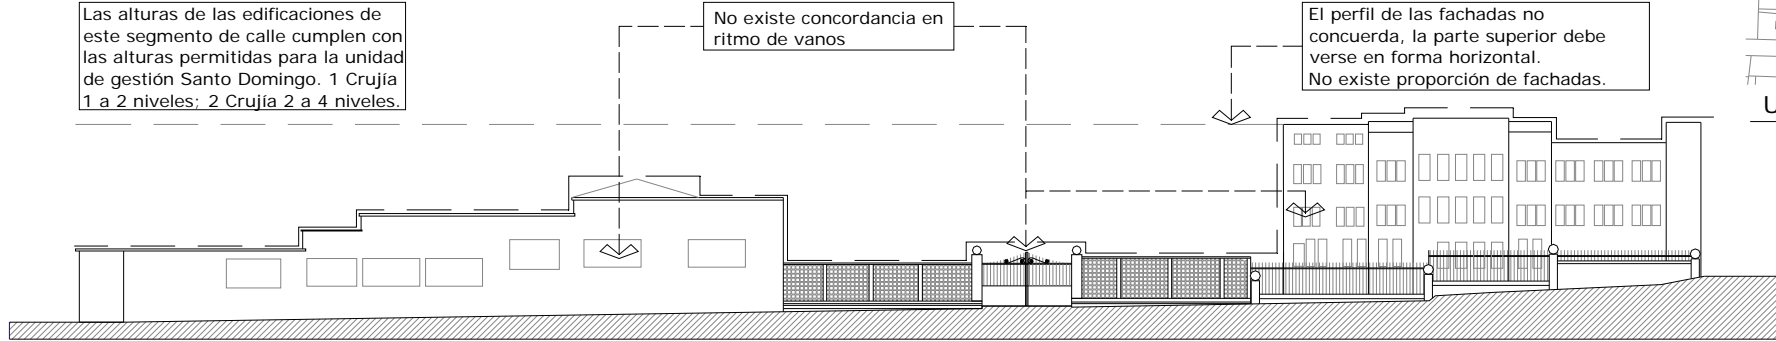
CALLE "A" SUR ENTRE 9 Y 10 AVENIDA. F - F1
